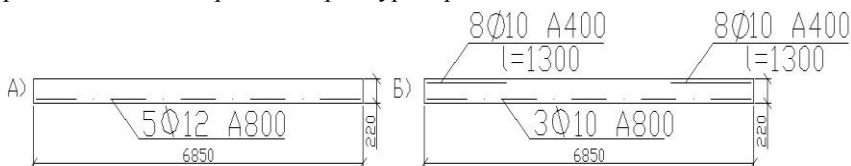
Схема армирования плит при шарнирном и жестком опирании
